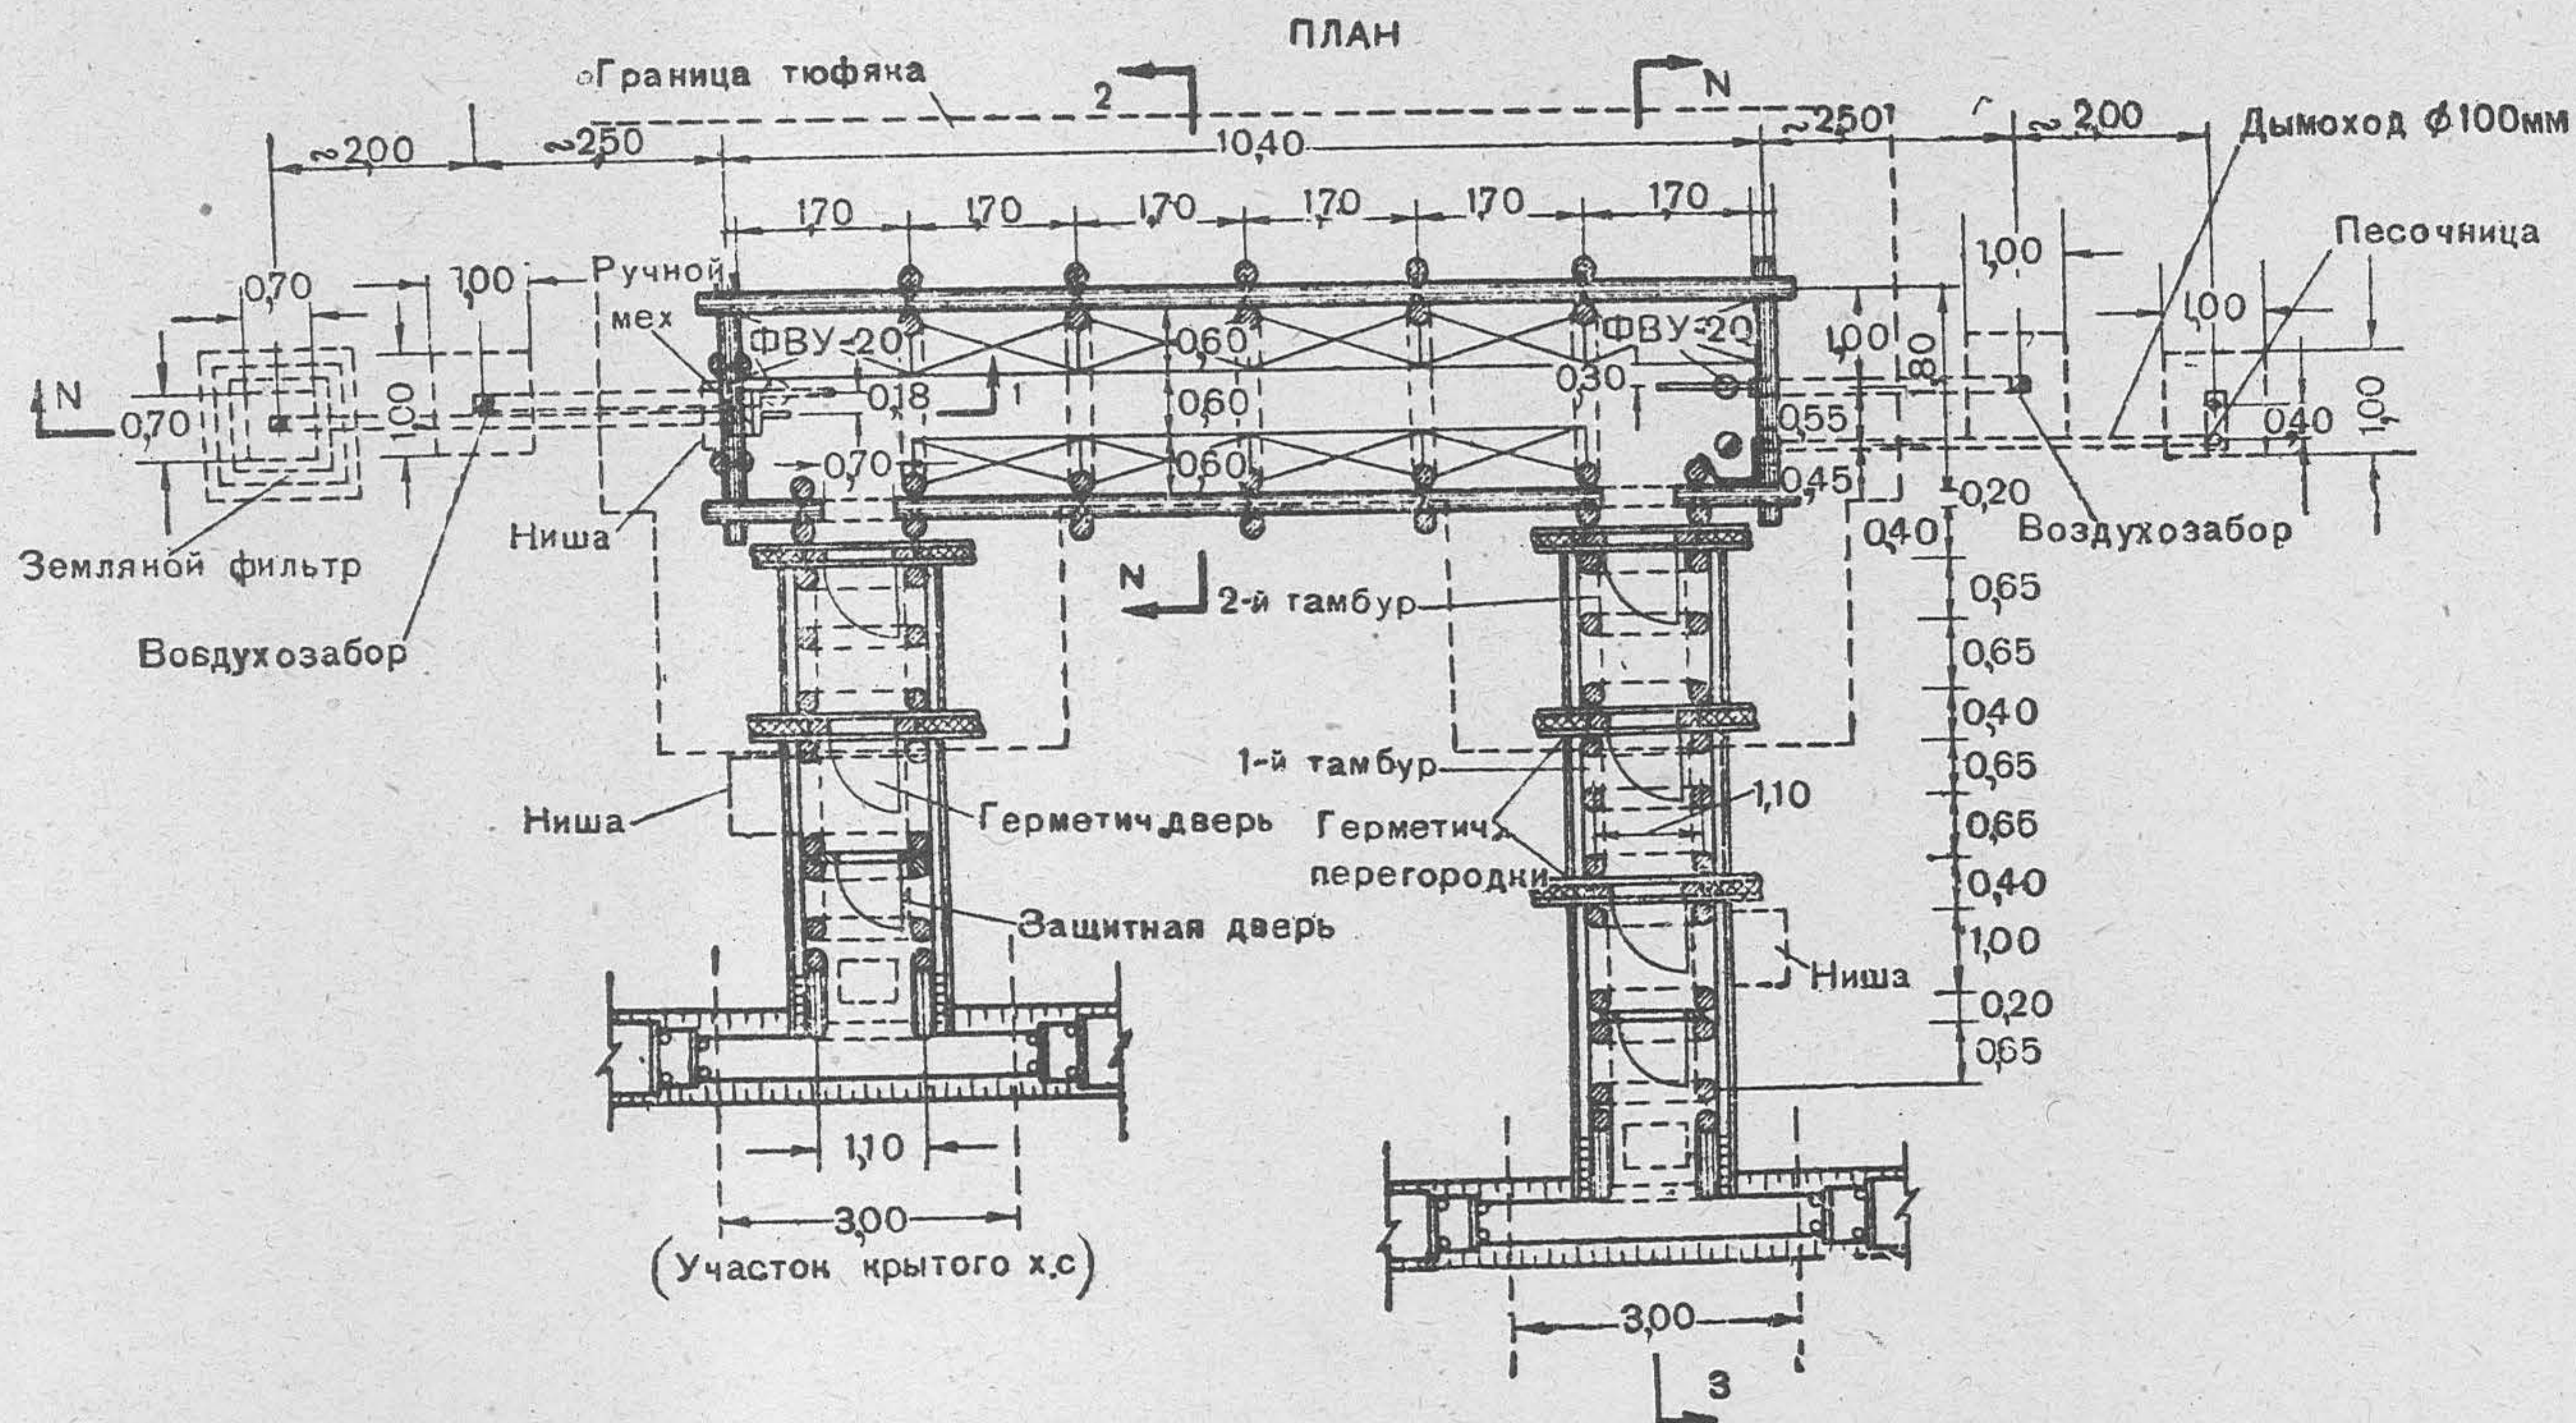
Котлованное убежище венчатой конструкции усиленного (или тяжёлого) типа на 20 бойцов
